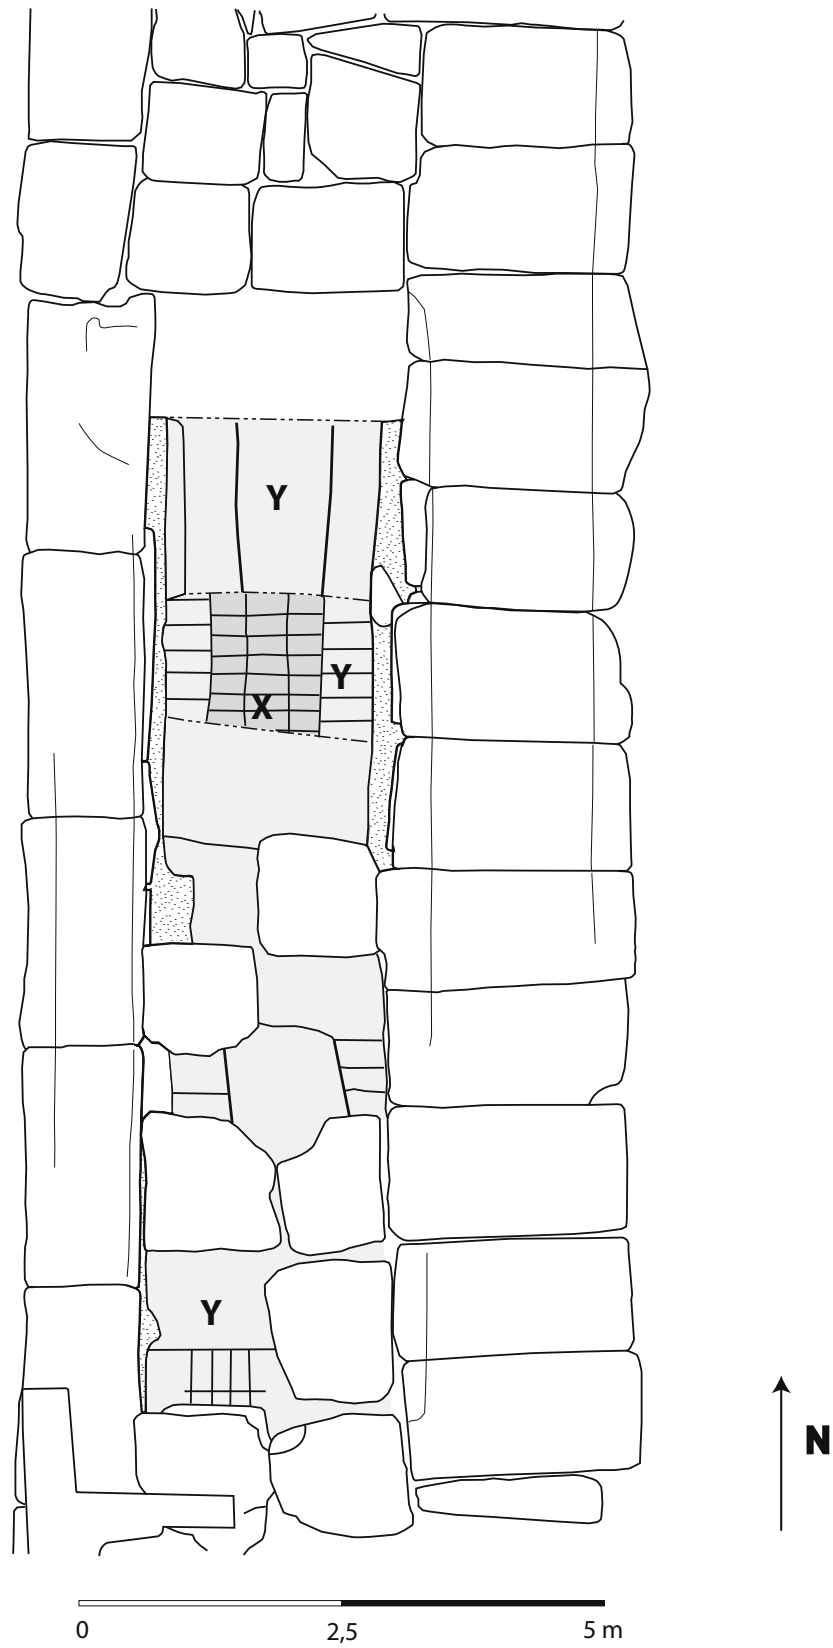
, Plan du magasin DB1.e.4, au 29 avril 1984 (relevé P. Gilbert, complété par T. Zimmer)
